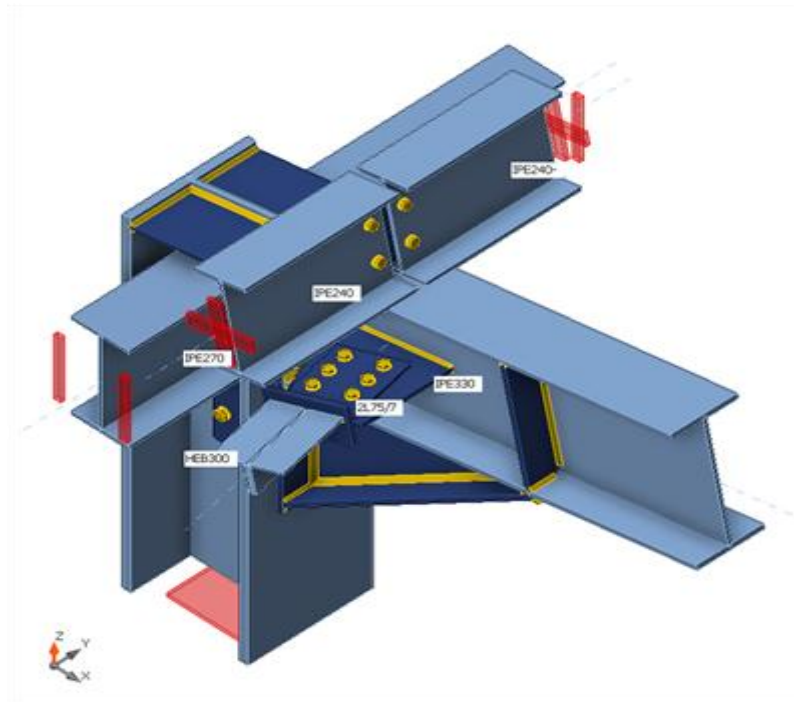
Vue 3D de L'assemblage poteaux-traverse.
